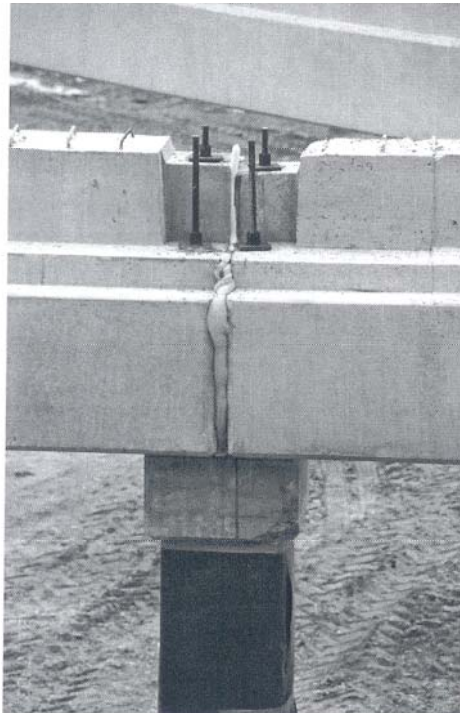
Ligação viga - pilar por aparafusamento [6]
